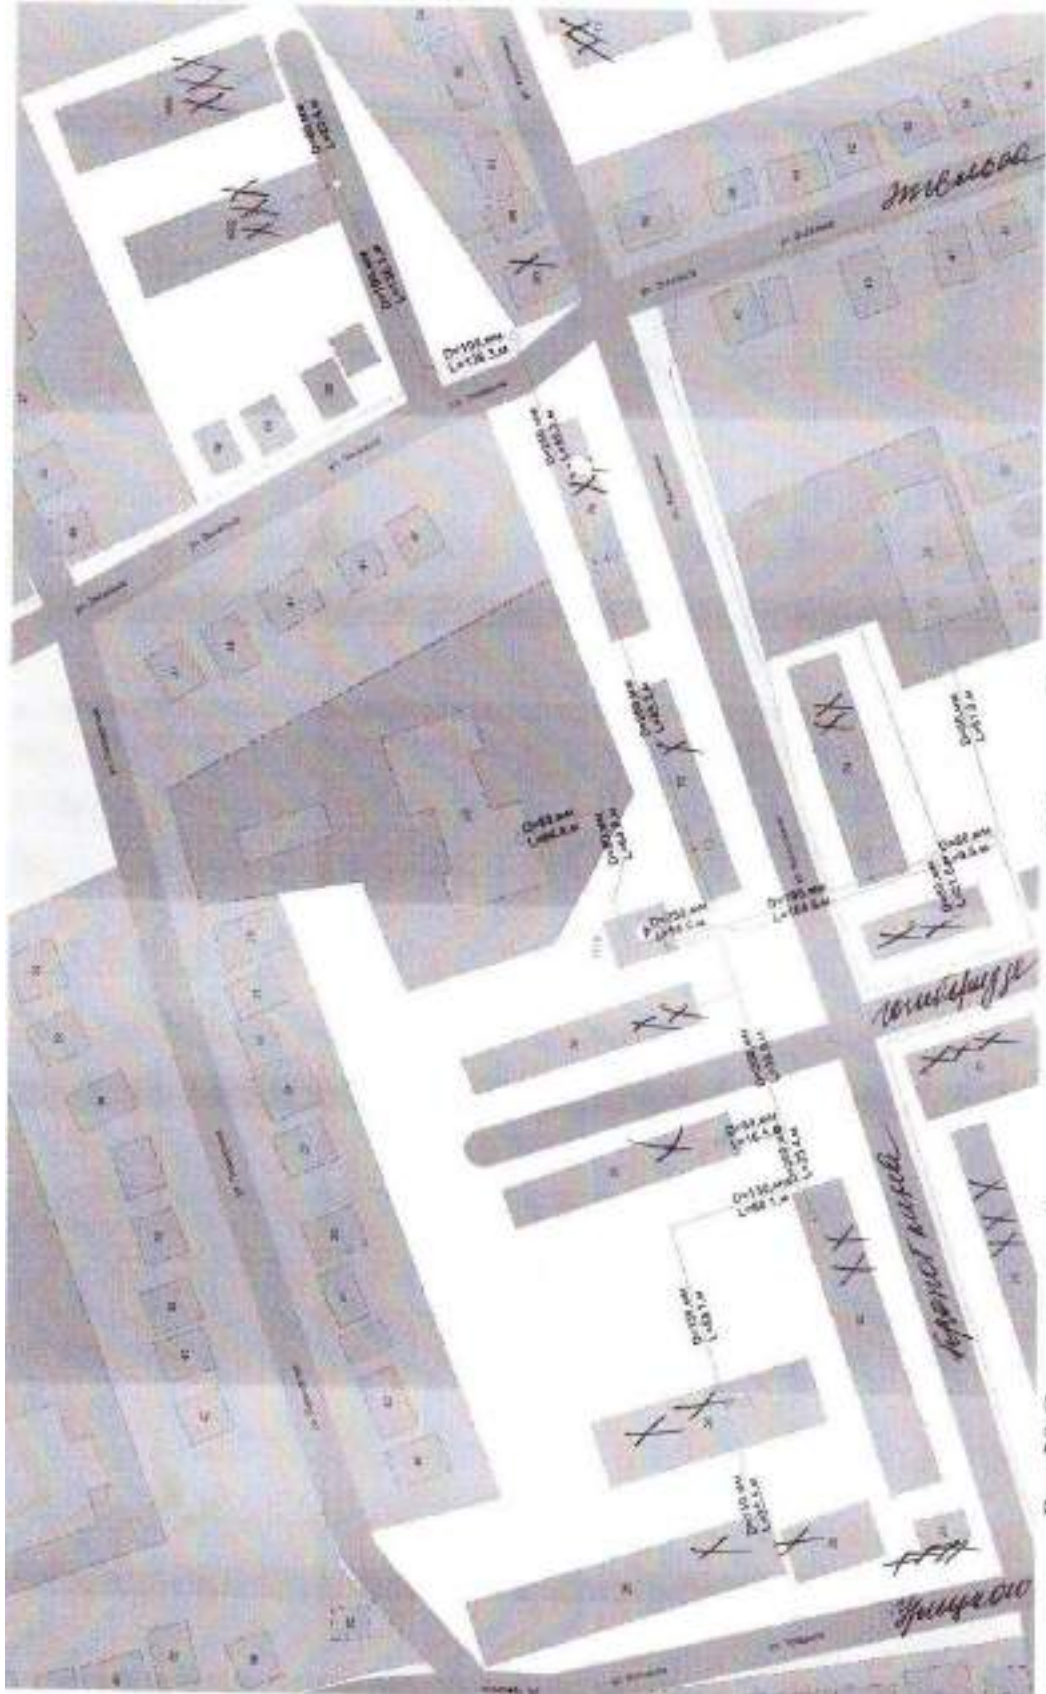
Схема тепловой сети от теплового пункта №8 по ул. Кропоткина от котельной ОАО ЛТЗ
